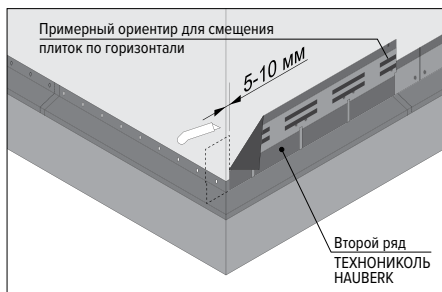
Монтаж первого и последующих рядов фасадной плитки
